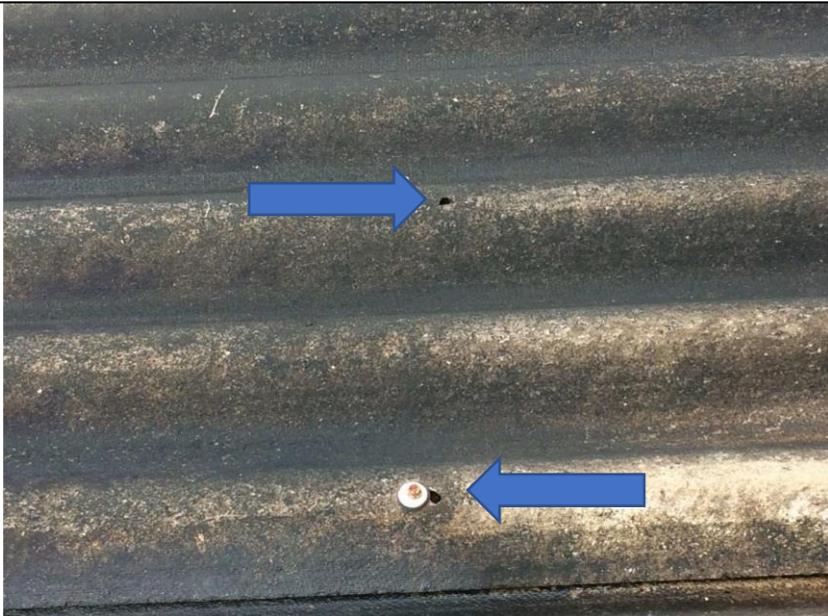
Coberta - Elemento de proteção da telha quebrado
